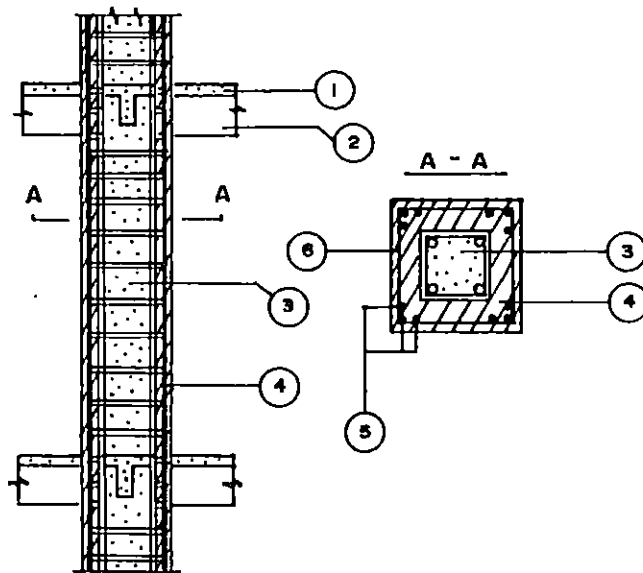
ENCAMISADO DE COLUMNA CON REFUERZO LONGITUDINAL ATRAVESANDO LOSA
